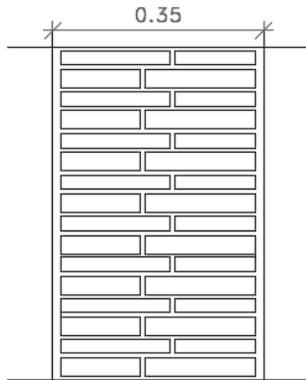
Detalle aparejo de fachada de pie y medio. Fuente: Propia de la autora
